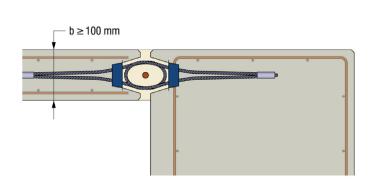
Wand – Wand – Eckverbindung - Regeldetail (vertiefter Einbau)
